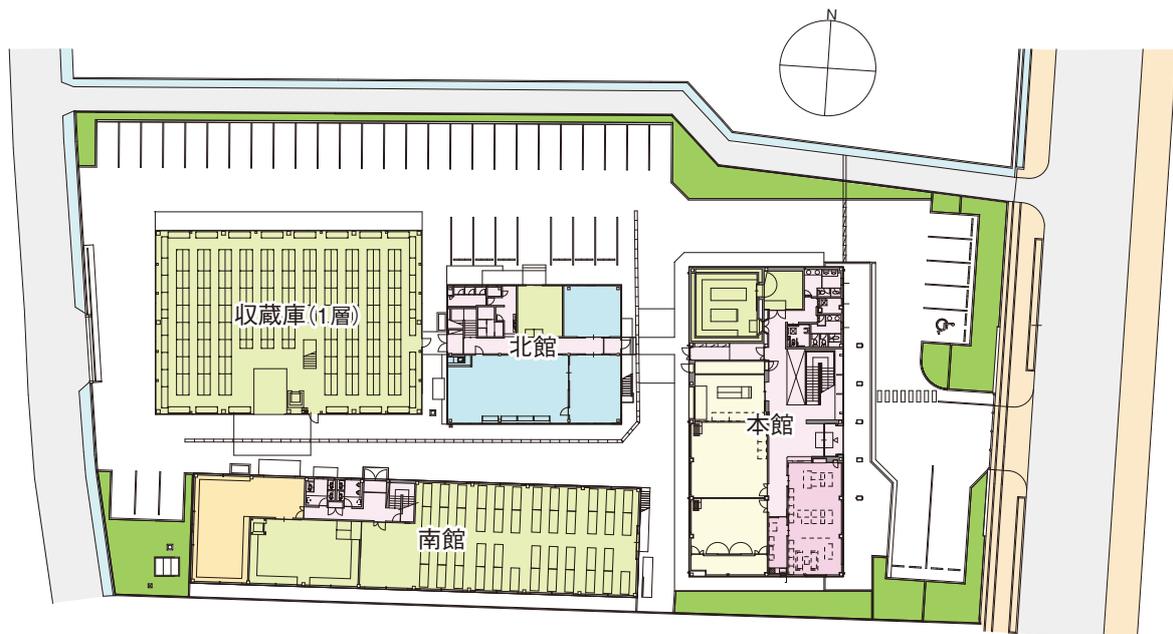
高知県立埋蔵文化財センター敷地と1F平面図(S=1/800)
